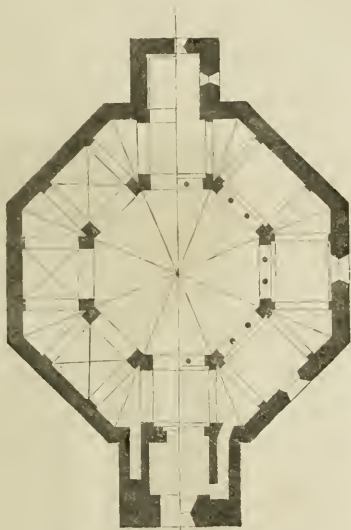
Grundriss der Kirche zu Ottmarsheim.
